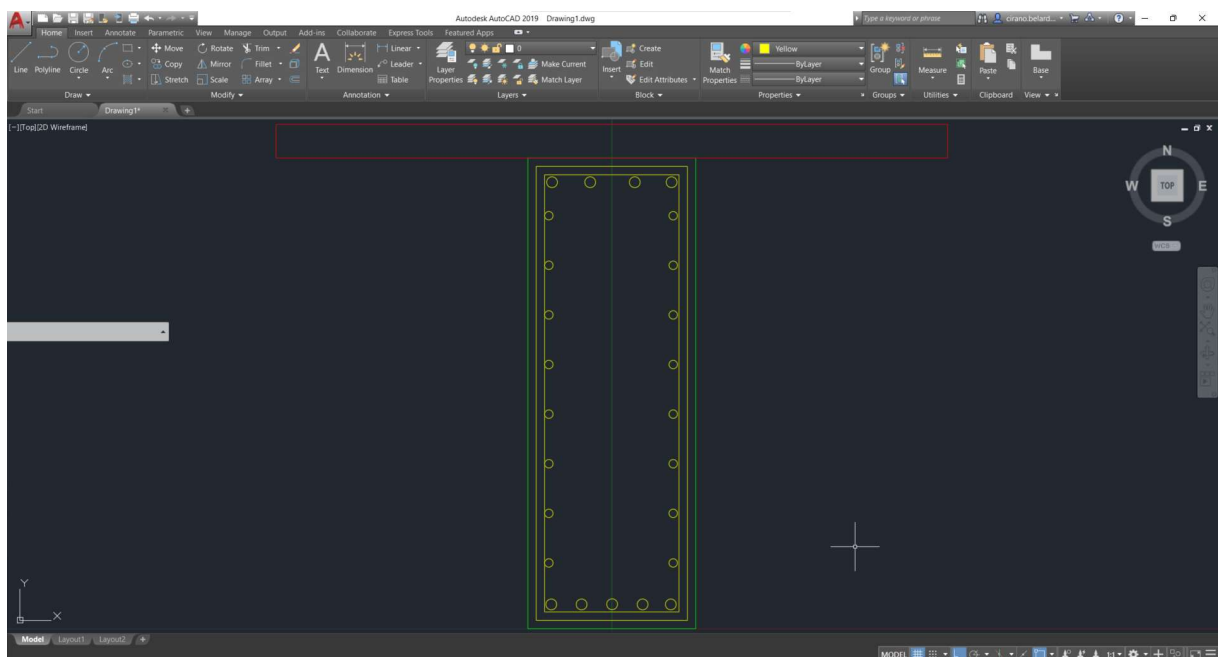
Seção da Viga Desenhada. Fonte: Autor.
